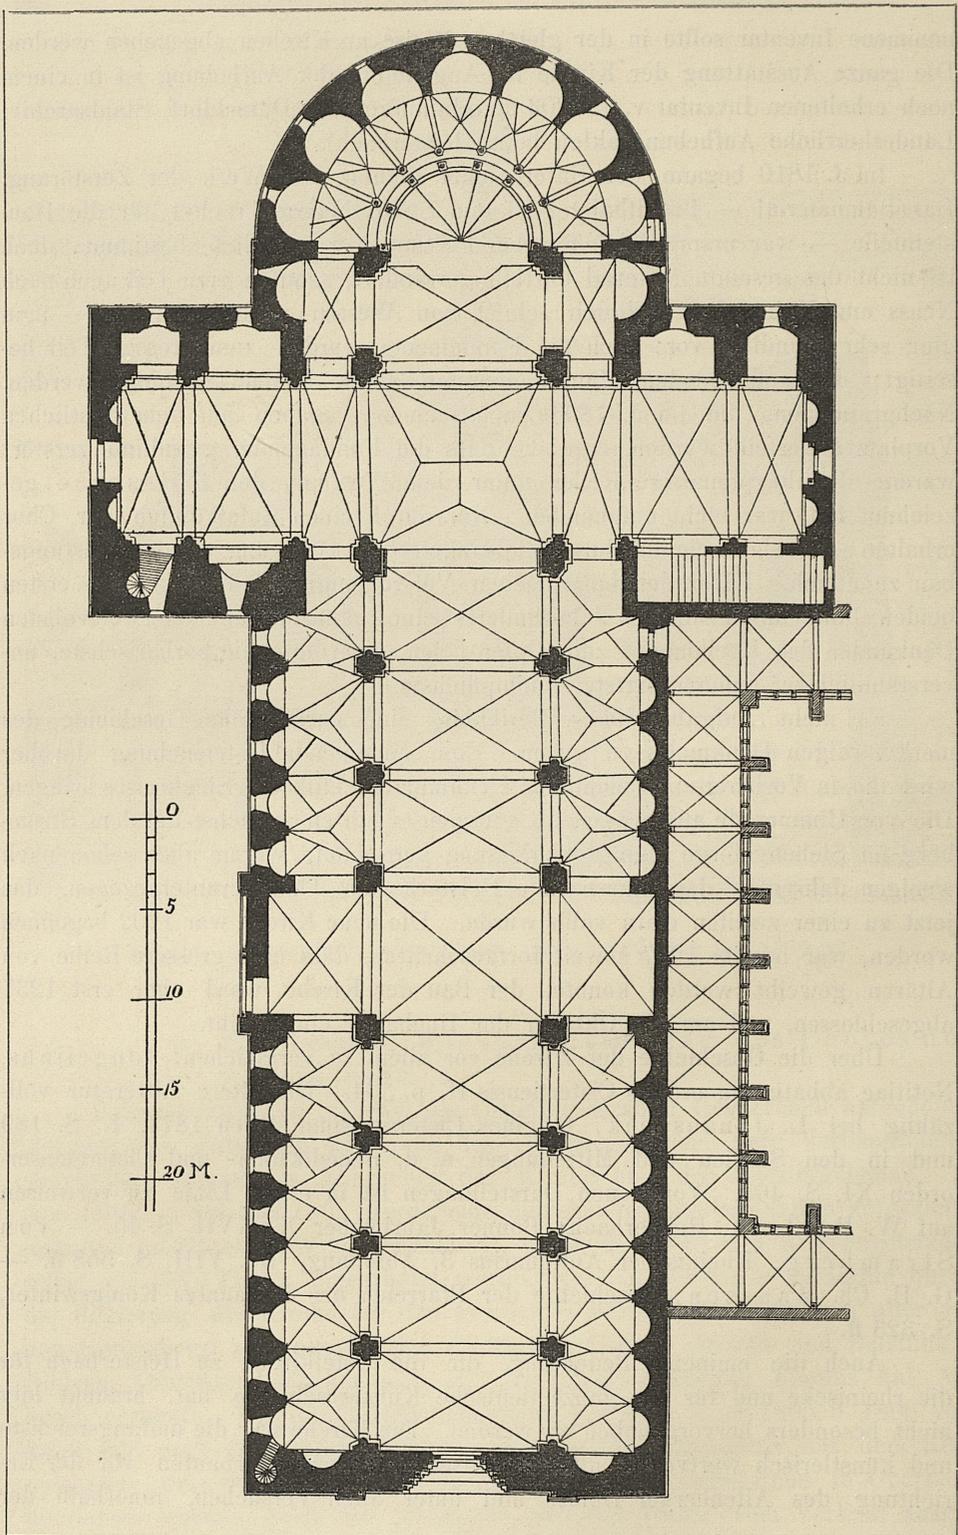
Heisterbach, Abteikirche. Grundriss nach Boisserée.
